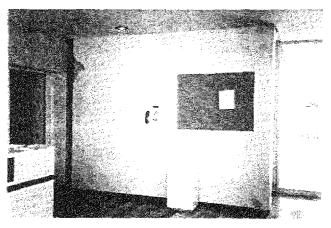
Daño ligero un muro divisorio de mampostería confinada
